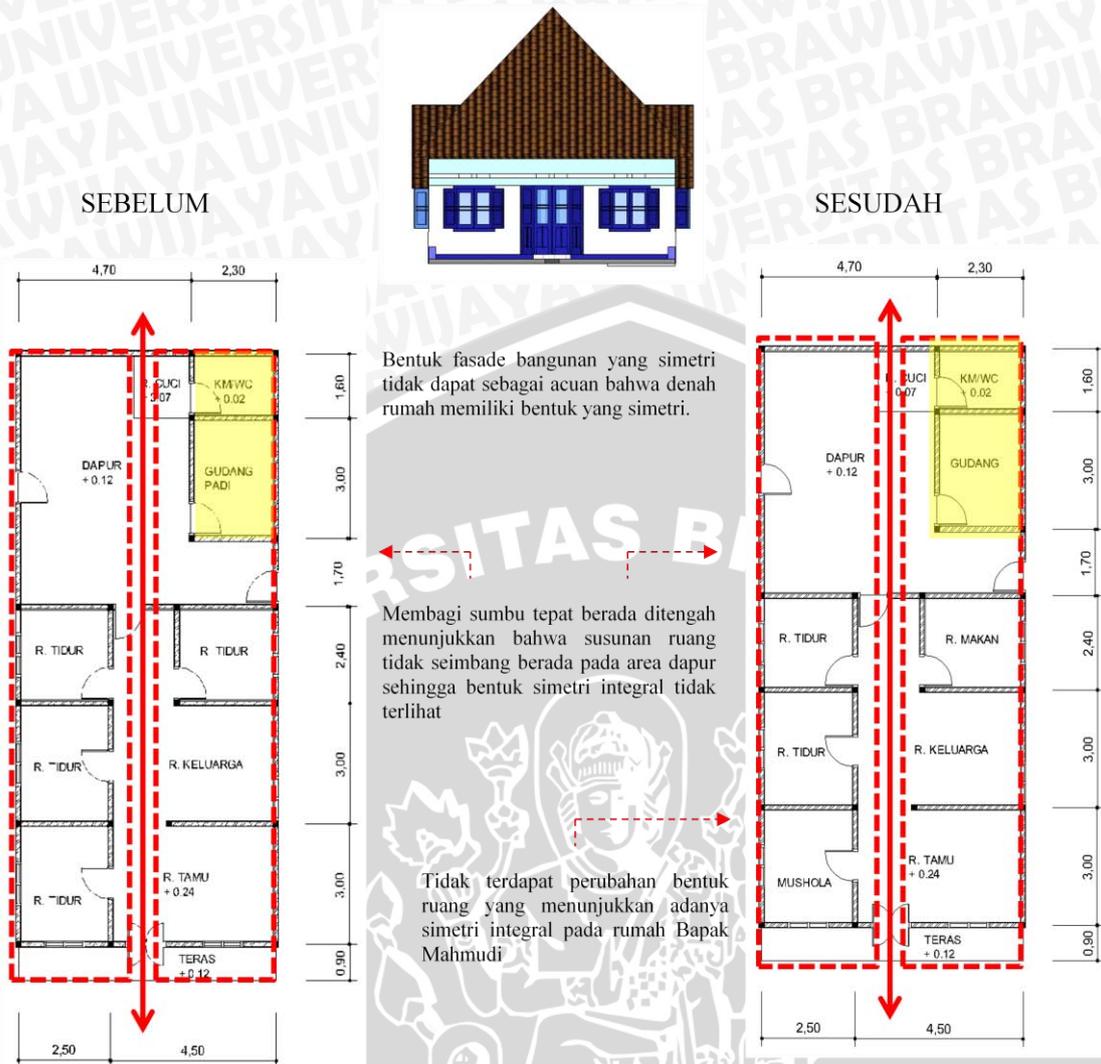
Denah dan pola ruang rumah Bapak Mahmudi
